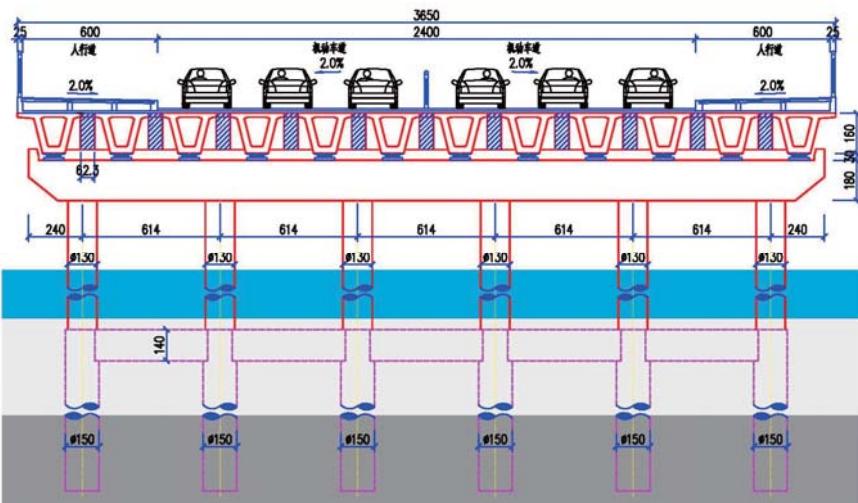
桥梁 A-A 断面图 (单位: cm)
